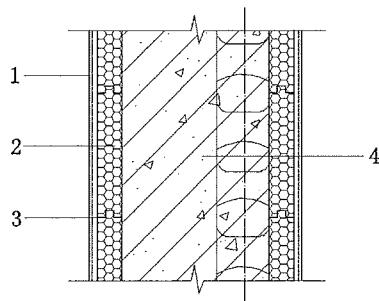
扶墙柱与墙体连接组合构造（垂直剖面）
